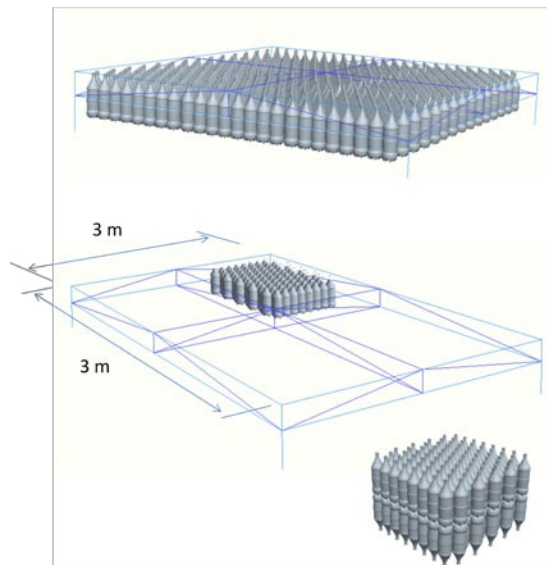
Botellas moduladas en sacos y fijadas con mallas por el pico.
